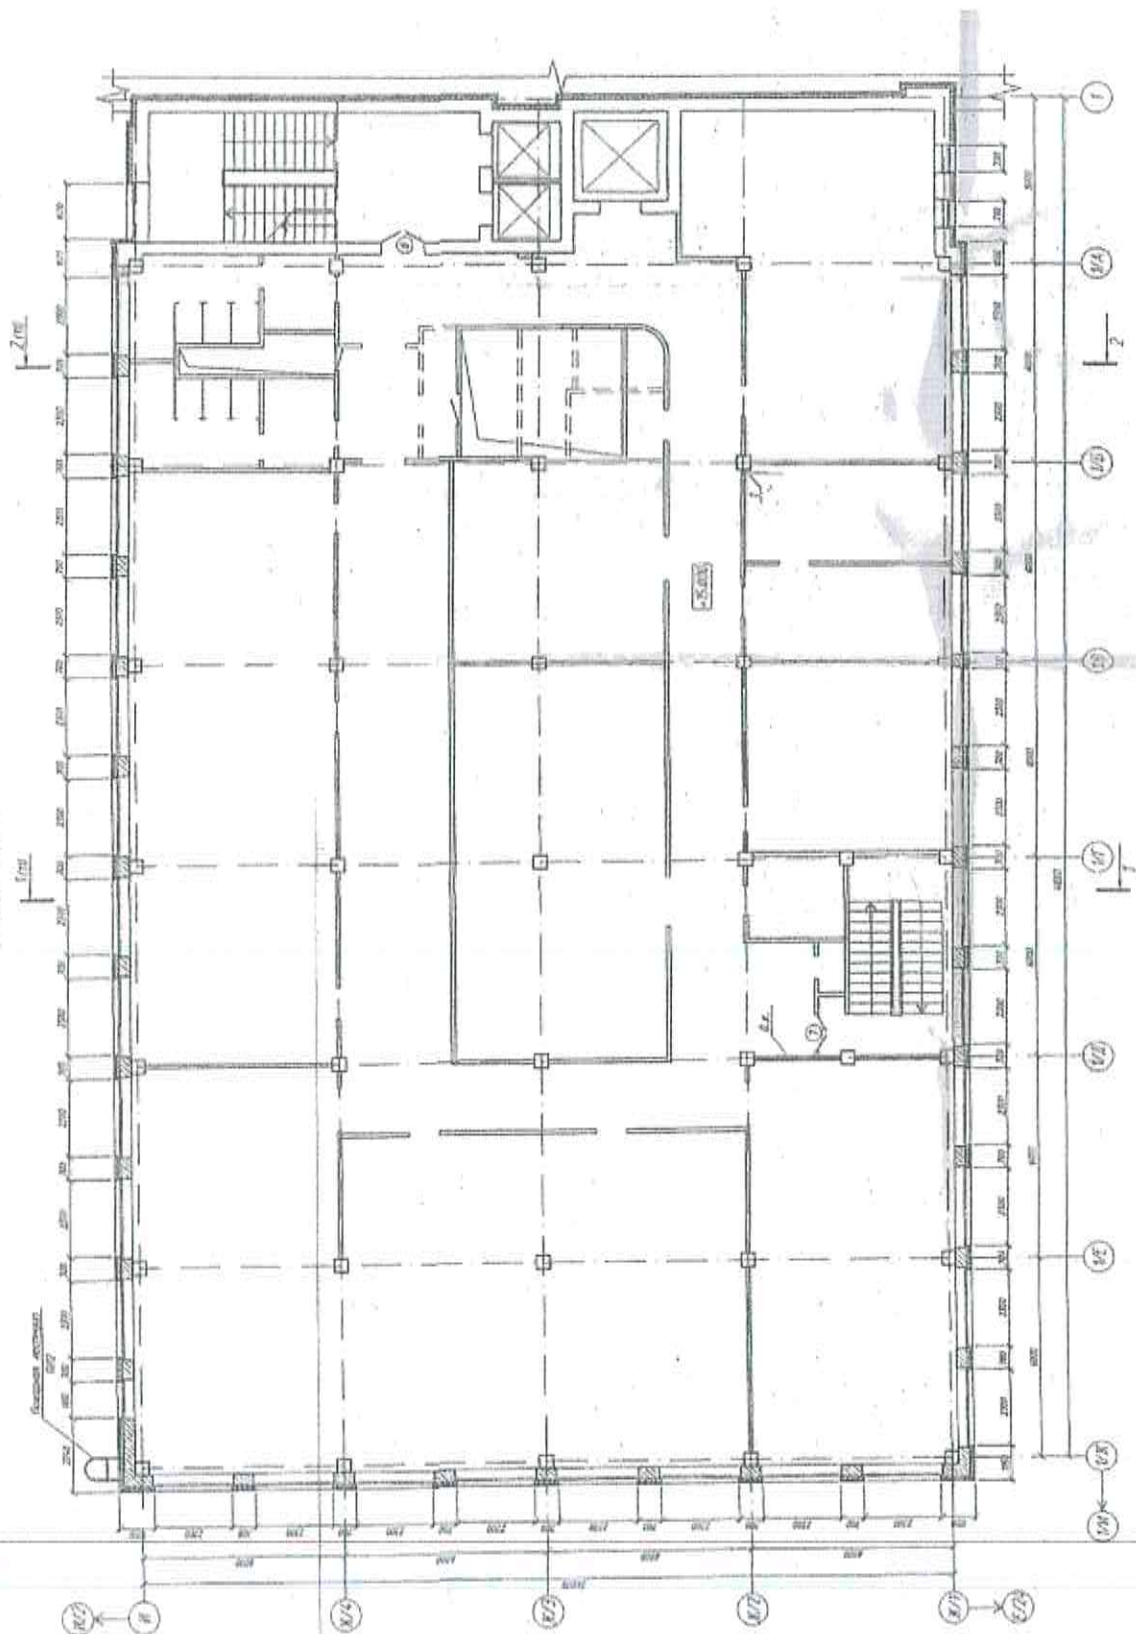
Проектная планировка 5-го этажа АБЧ
